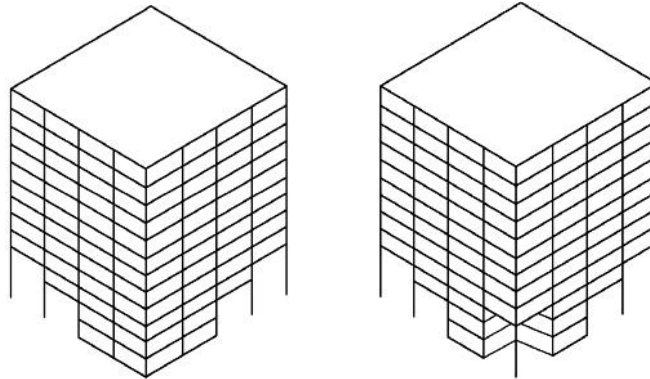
Ejemplos de cambios bruscos de áreas de planta en entrepisos contiguos que llevan a estructuras irregulares en elevación (Arnold y Reitherman 1986).
